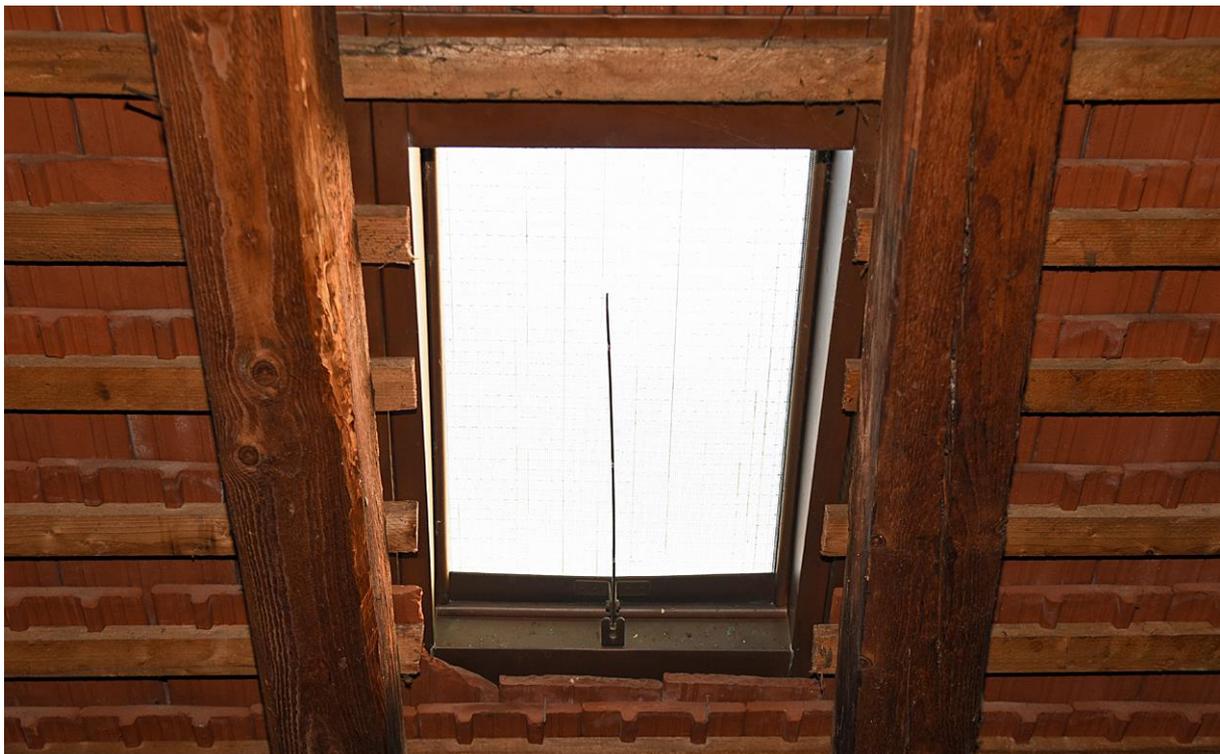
Dachflächenfenster vor dem Umbau. Foto: C. Dietz.
